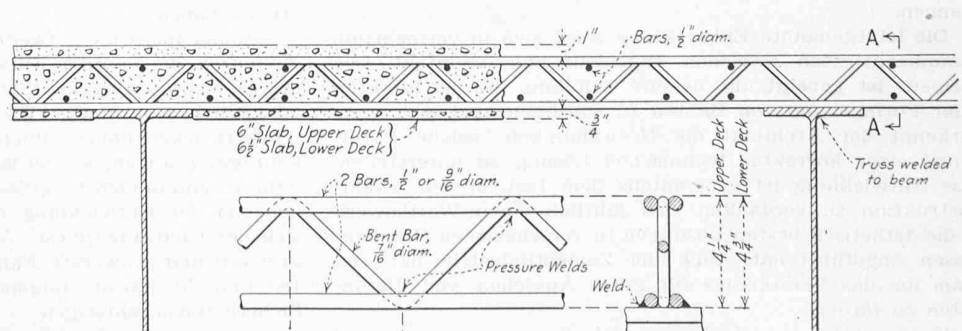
Beton-Fahrbahntafel armiert mit geschweissten Fachwerkträgern. — Masstab 1:15
